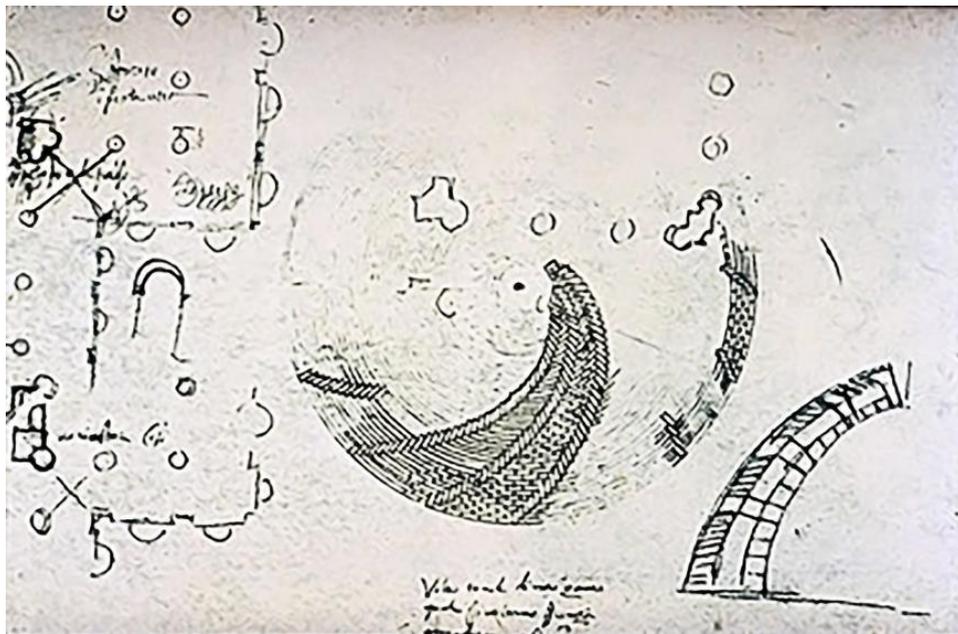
Structure et plan du dôme de Florence, croquis de Brunelleschi, vers 1420
